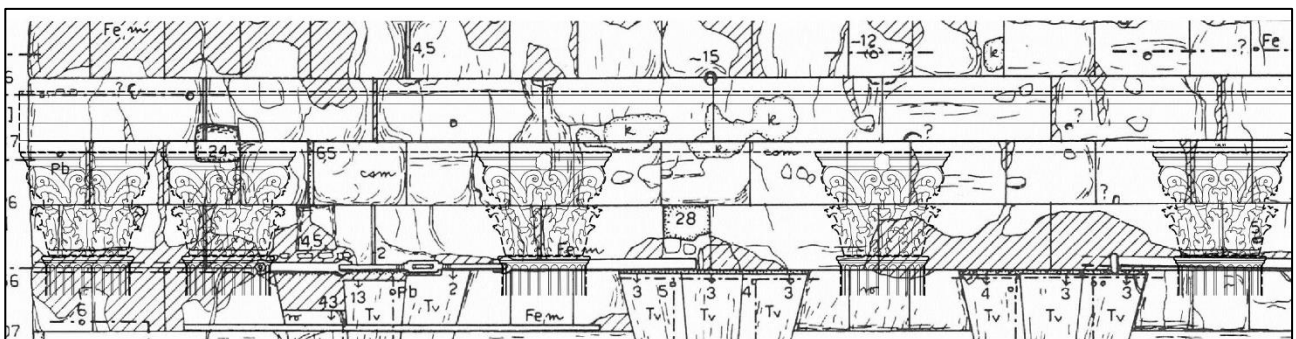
Rilievo di Bauer dell'esedra sud rielaborato con ricomposizione dell'architrave e di parte dell'elevato ROSSO
